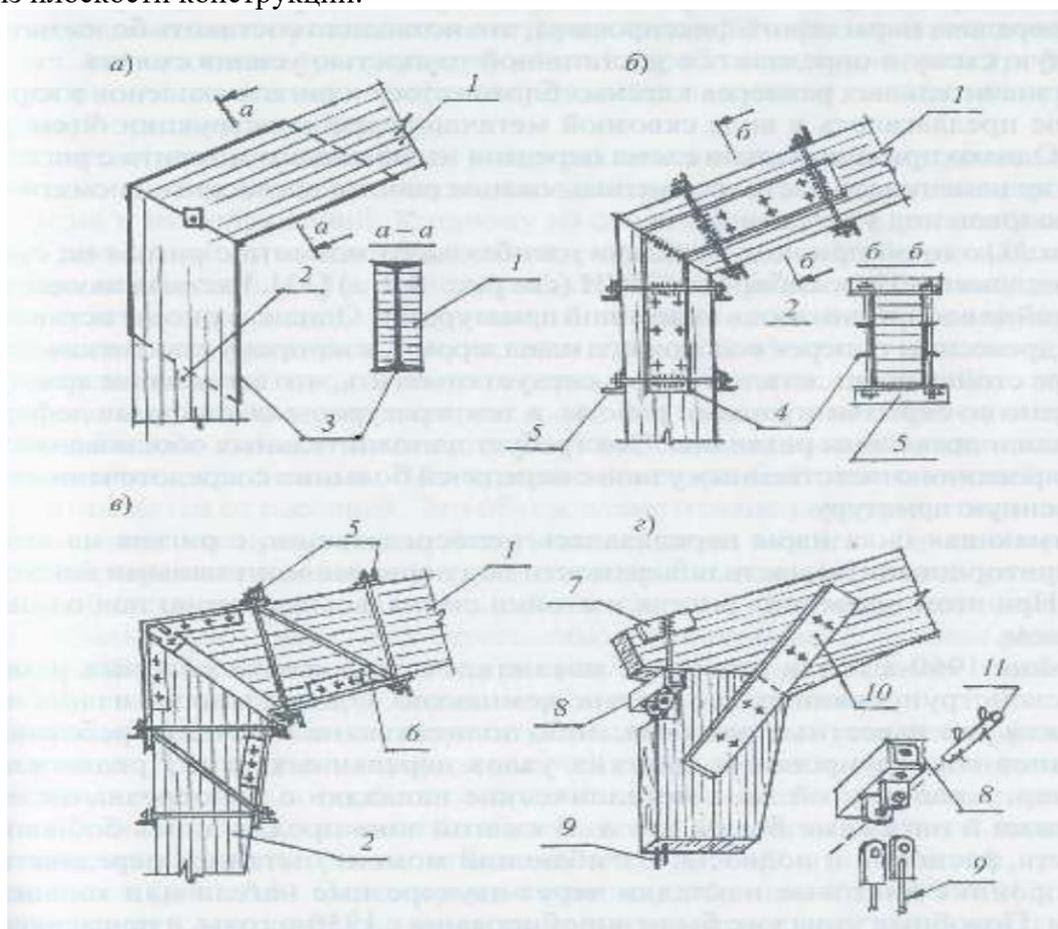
Жесткие узлы соединения ригеля 1 со стойкой 2 дощатоклееной рамы: а – «колена» из двутавров 3; б – «колена» из парных швеллеров 4 с использованием уголков 5 соединенных болтами; в - система из арматурных стержней 6; г – передача растягивающего усилия через швеллер 7 и металлические детали 8 на клеенную стойку арматуры 9, 10 – парные накладки на болтах, 11 – шпилька.
